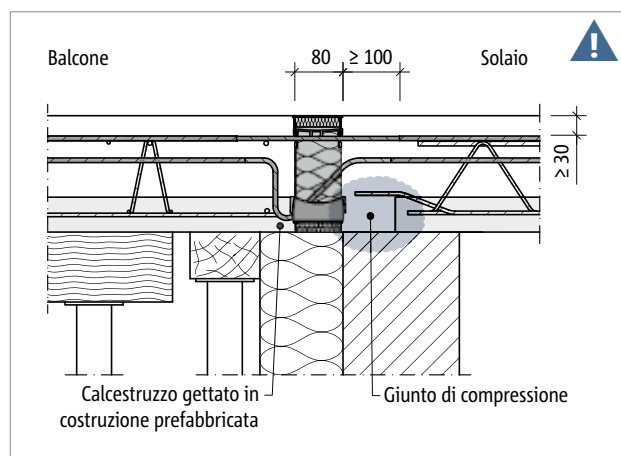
Schöck Isokorb® T tipo K-F: montaggio con solette semiprefabbricate (qui: $h \leq 170$ mm), appoggio diretto, giunto di compressione lato solaio
